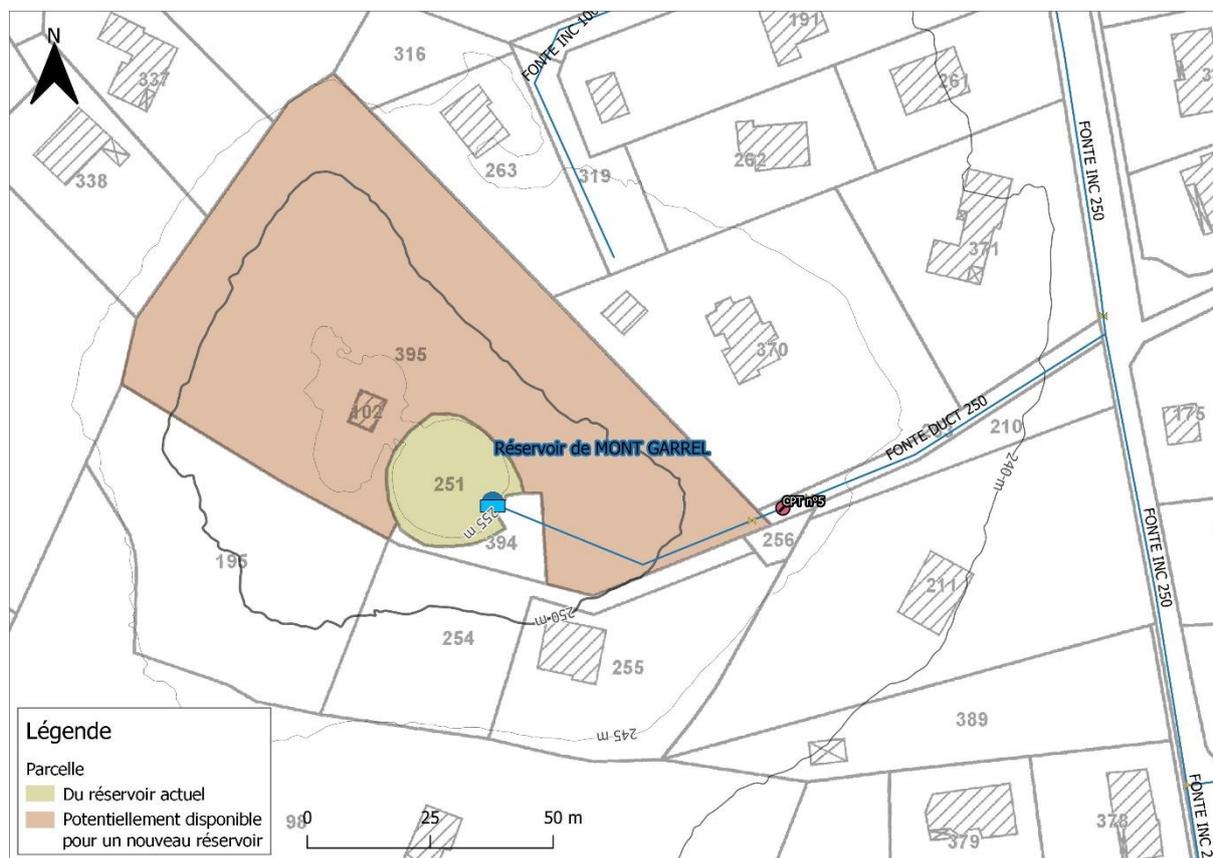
Proposition d'un nouveau réservoir sur le site de Mont Garrel
